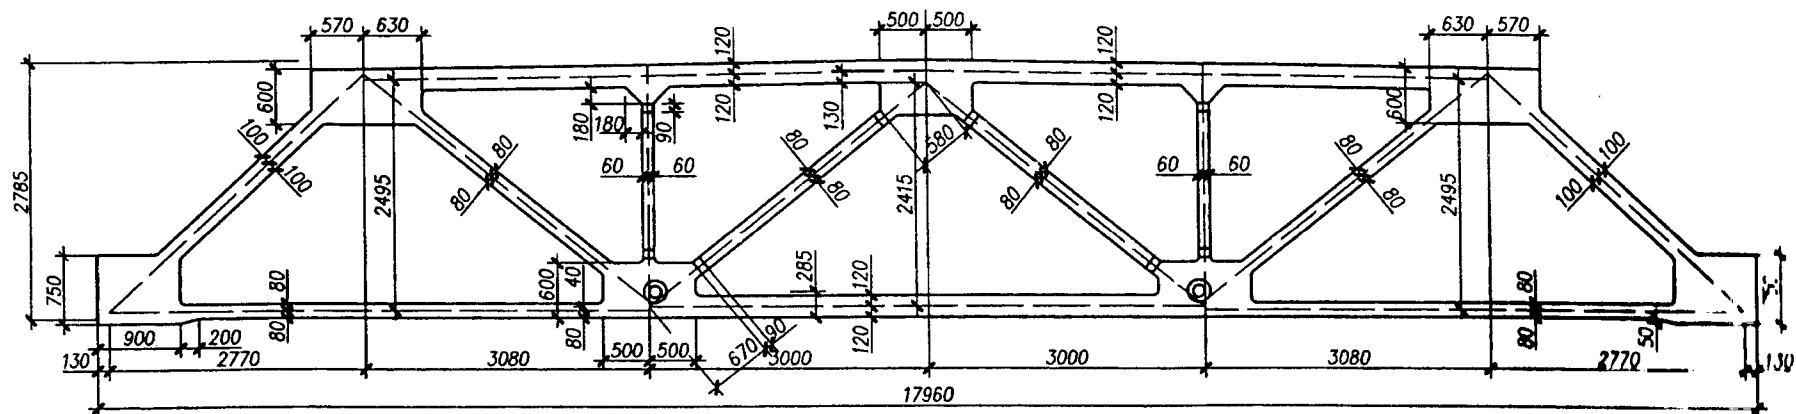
Полигональные железобетонные фермы с пониженной высотой на опорах (второго и третьего типа)
